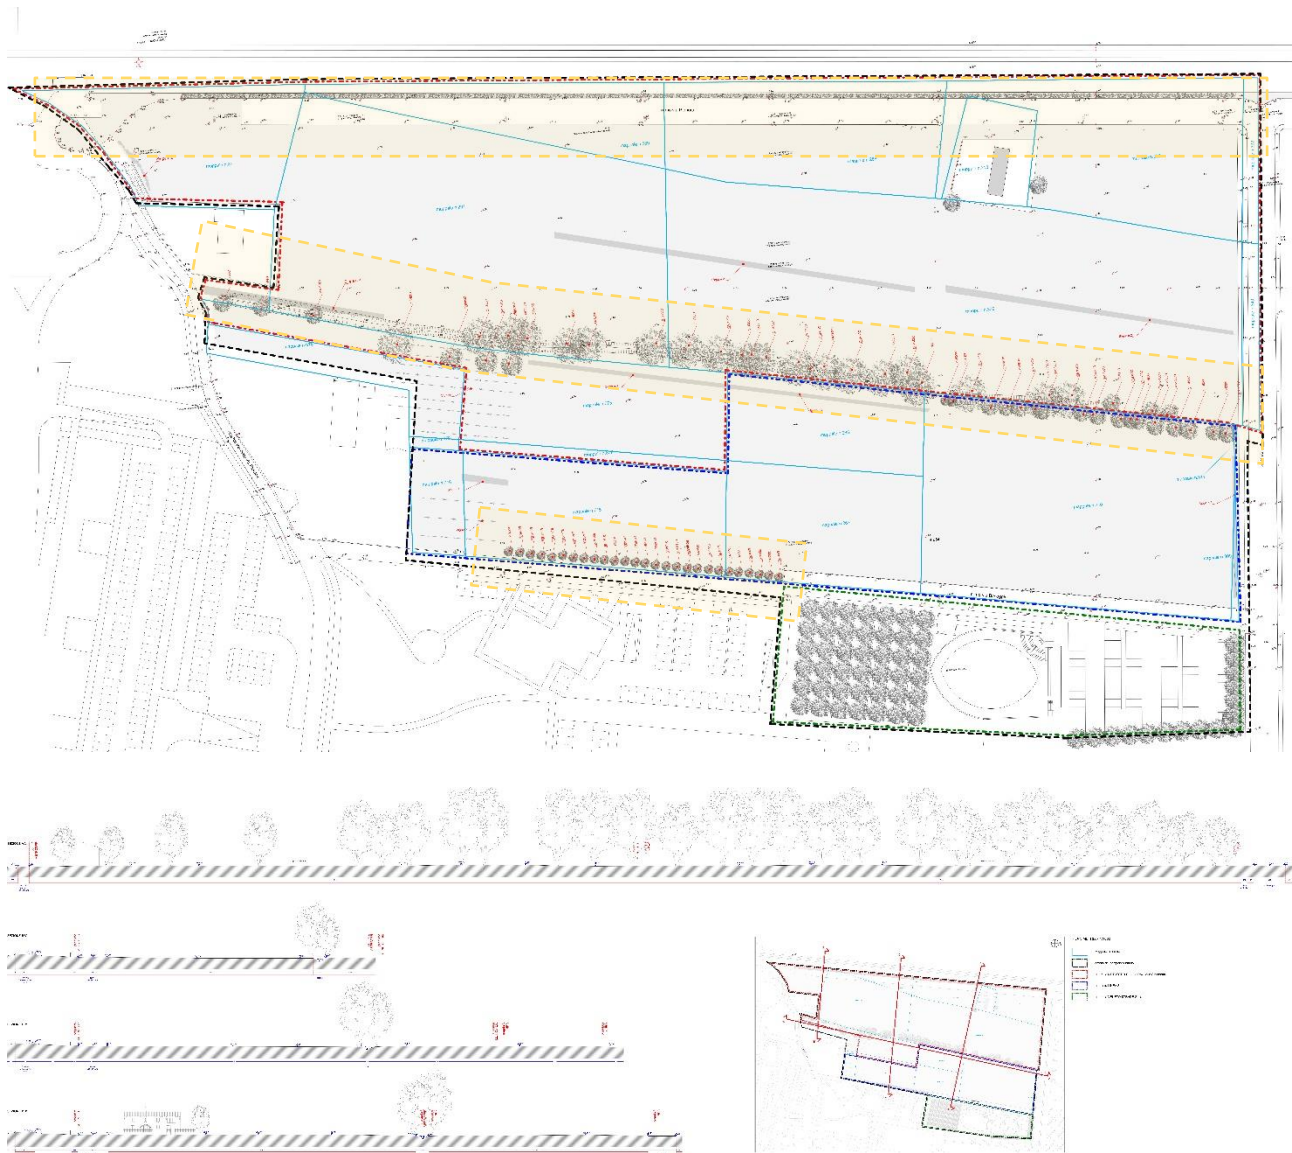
Rappresentazione planimetrica e sezioni dello stato di fatto con evidenziazione delle aree alberate (Fonte: Stato di fatto – Rilievo Planoaltimetrico – AI Progetti)
